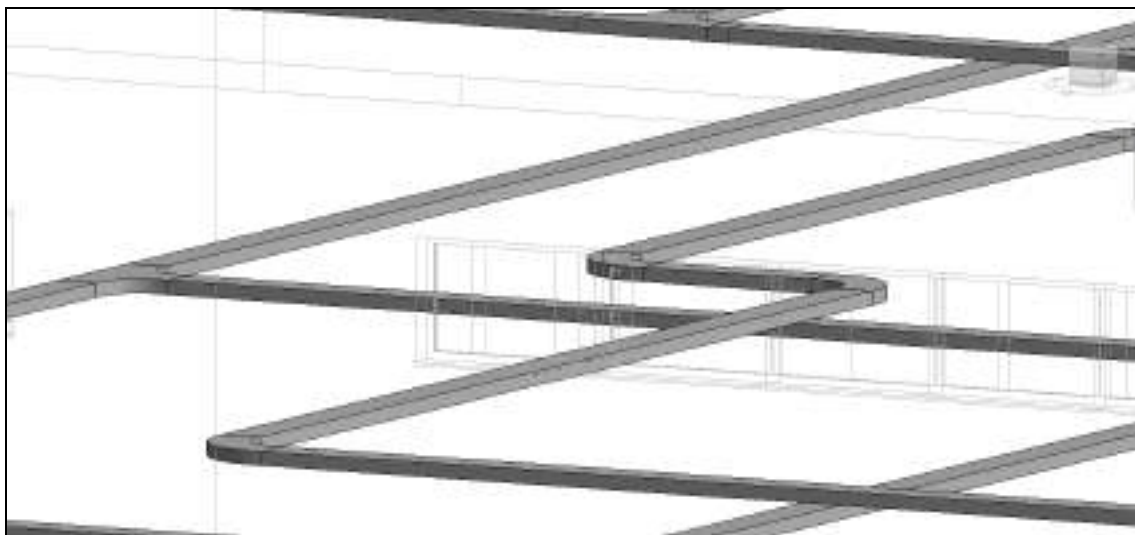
Modelado de Instalaciones eléctricas (Bandeja de Cables -Vista 3D)
